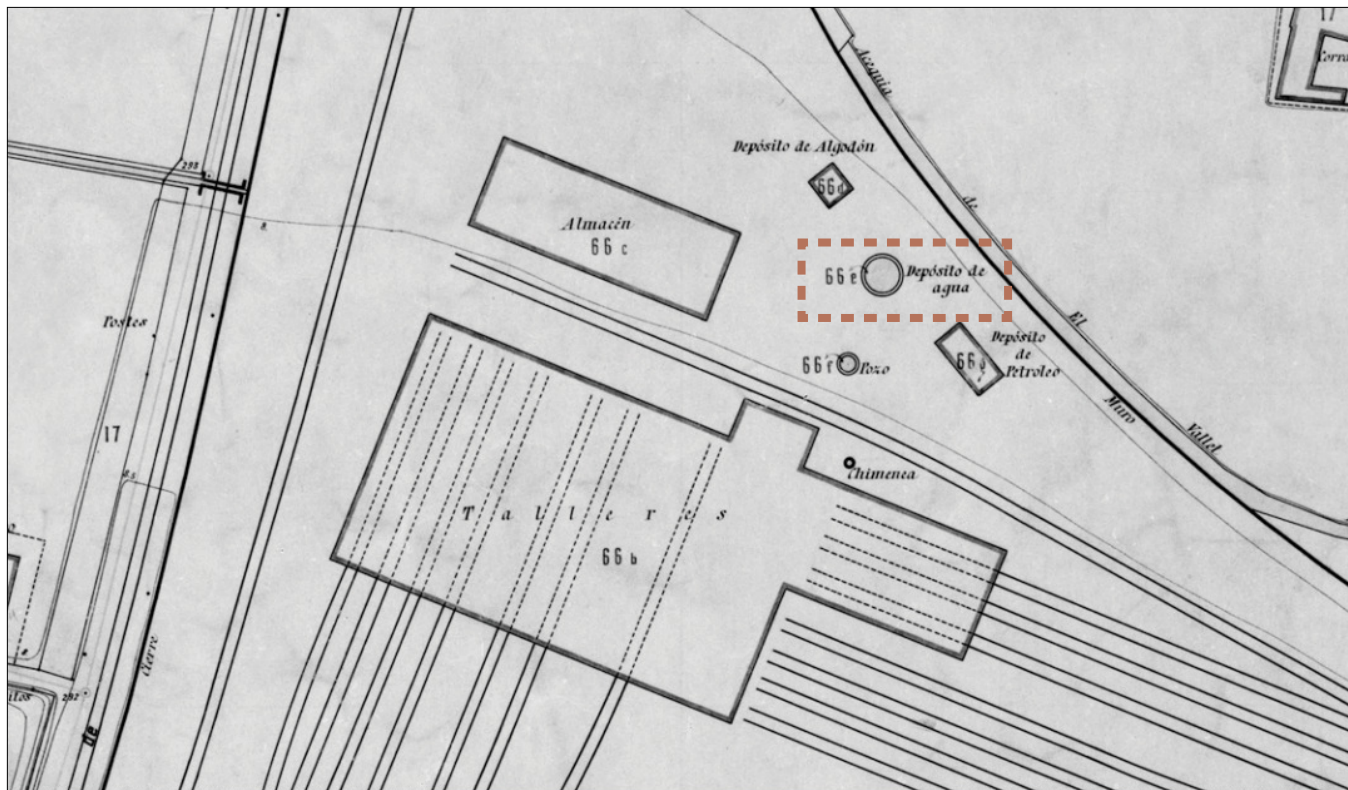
Planta donde se localiza el depósito y talleres en el Parcelario de 1929-1944
